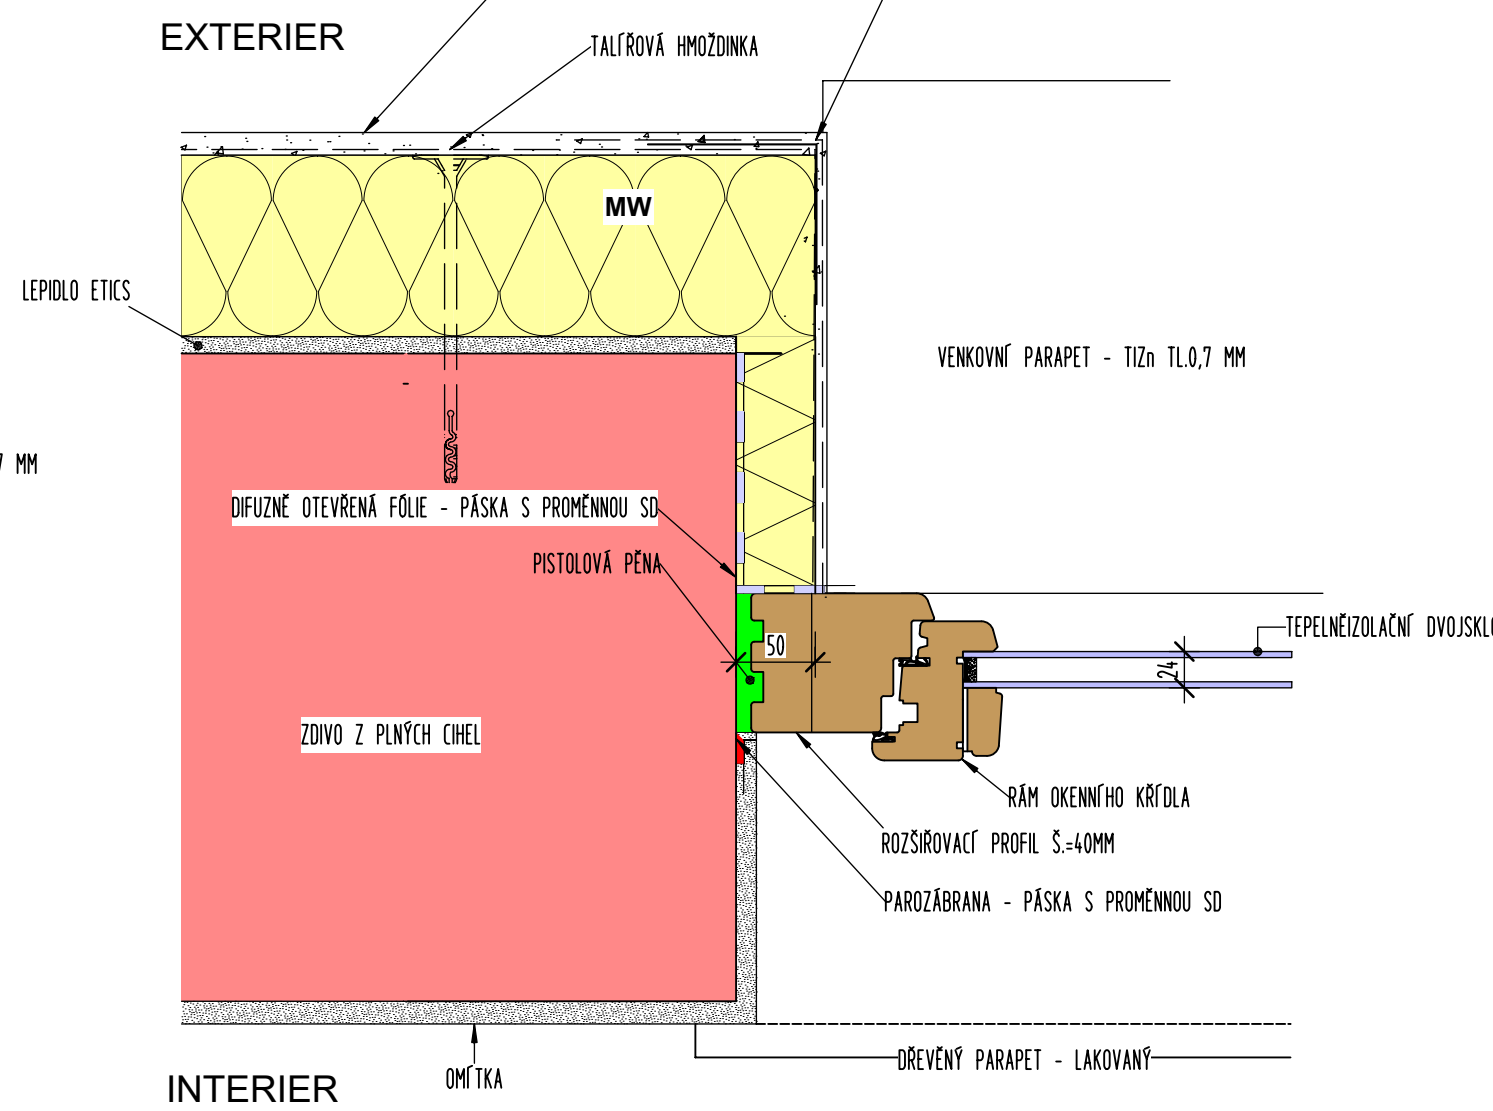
DETAIL ETICS U PARAPETU OKNA/ZDIVO M 1:5
